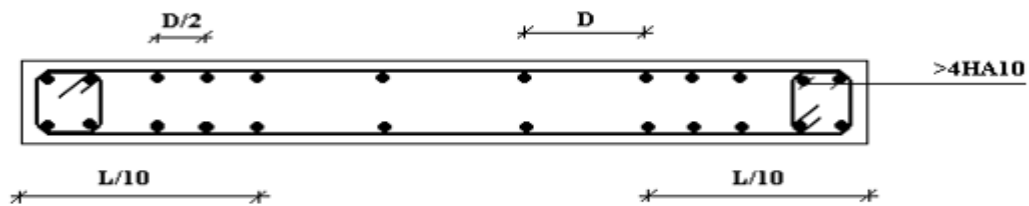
Disposition des Armatures verticales dans les voiles.
